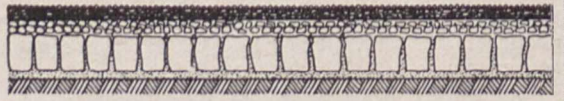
Zweischichtiger Walzasphalt auf vorhandener Chaussierung.
